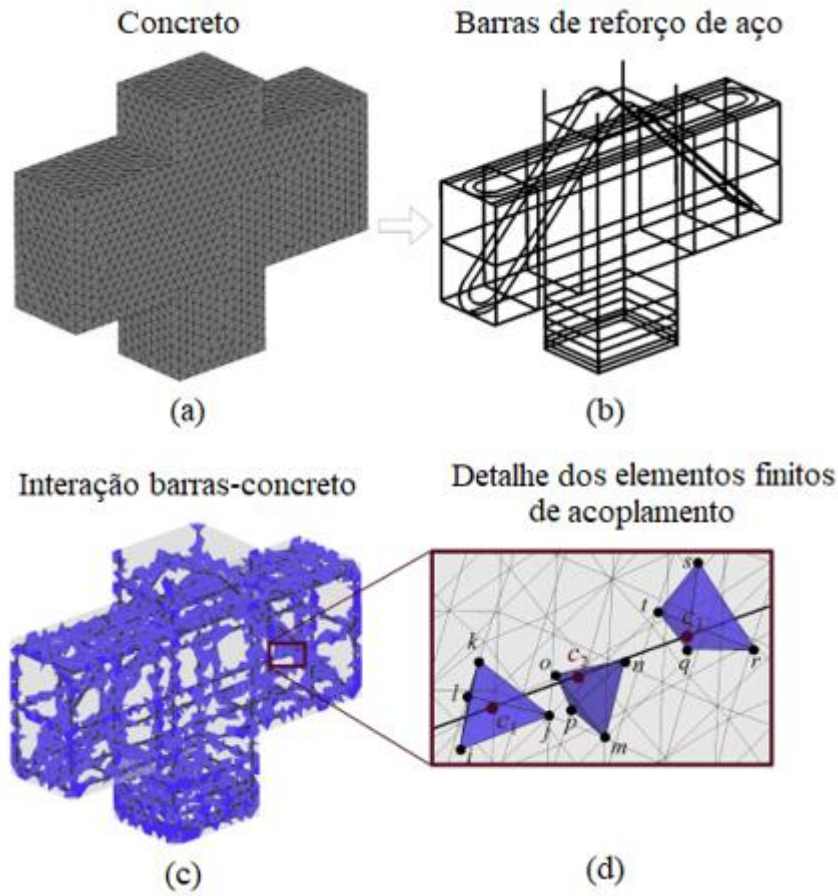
Definição do modelo numérico para consolo de concreto armado baseado em EFAs: (a) geração da malha de concreto; (b) geração dos vergalhões e correspondente discretização; (c) procedimento de acoplamento; e (d) detalhamento dos EFAs (Adaptada de BITENCOURT et al., 2018).
